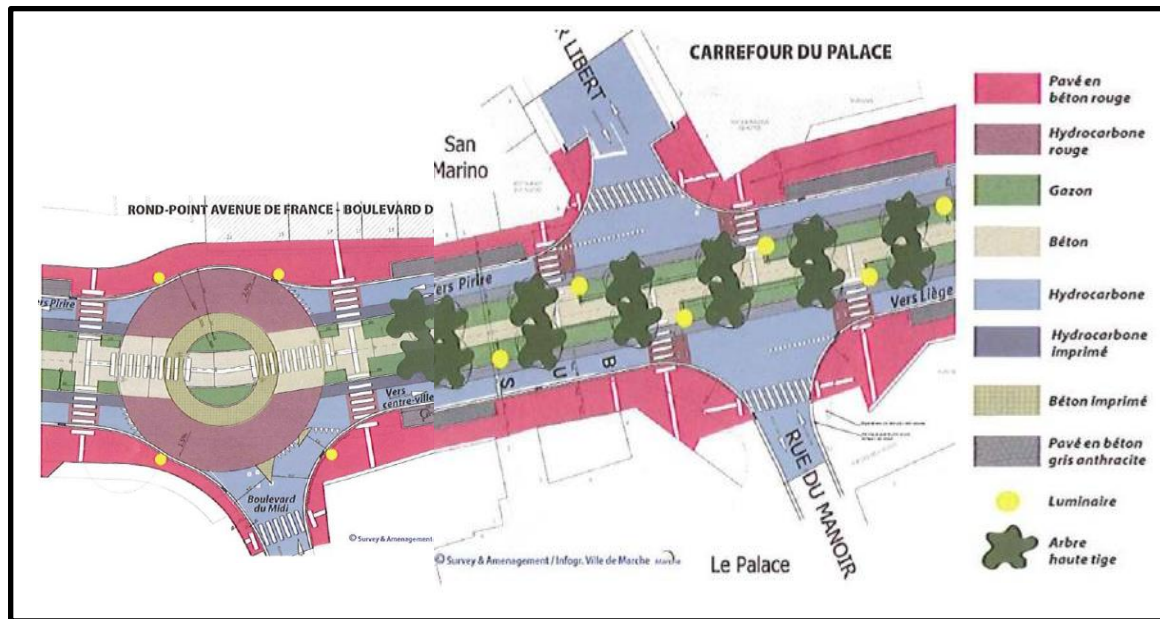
Plan d'aménagement du boulevard urbain de Marche-en-Famenne (traçon-1&2)
